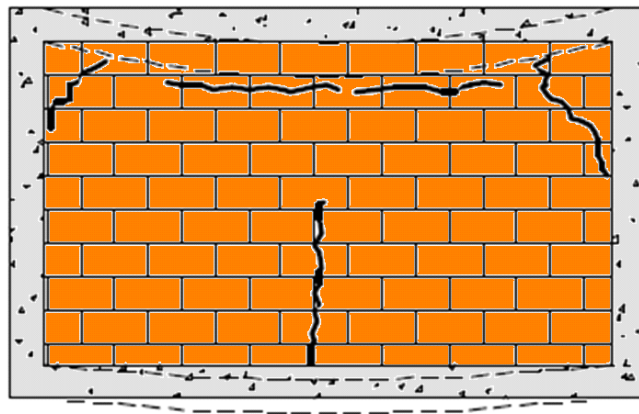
Deformação das vigas: flecha da viga inferior menor do que da viga superior – a parede se comporta como uma viga solicitada à flexão (adaptada de Pffermann, 1968).
